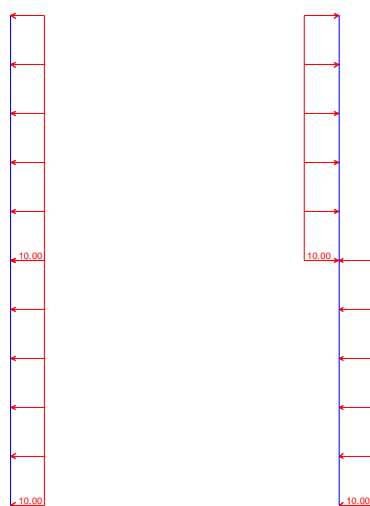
Estruturas genéricas para demonstração de comportamento do núcleo excêntrico
